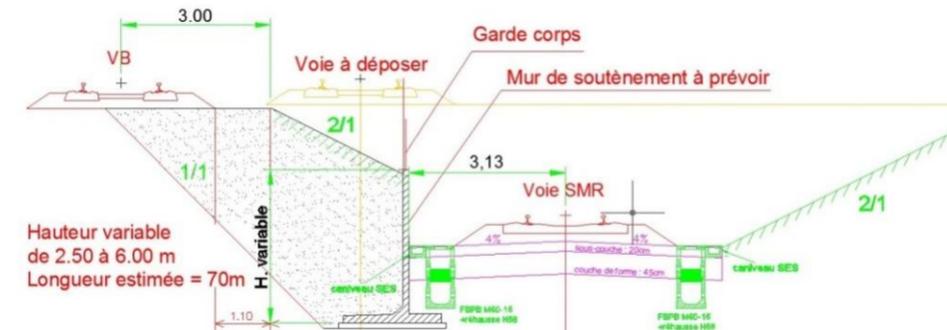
Coupe de principe du mur de soutènement du SMR (Source : AVP- juillet 2015)
